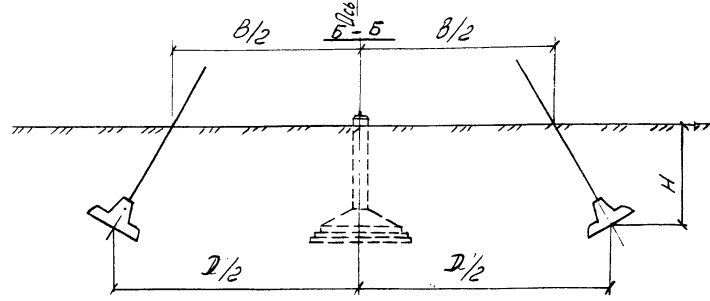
Схема фундаментов под промежуточно-узловую опору ПУБ-5.
